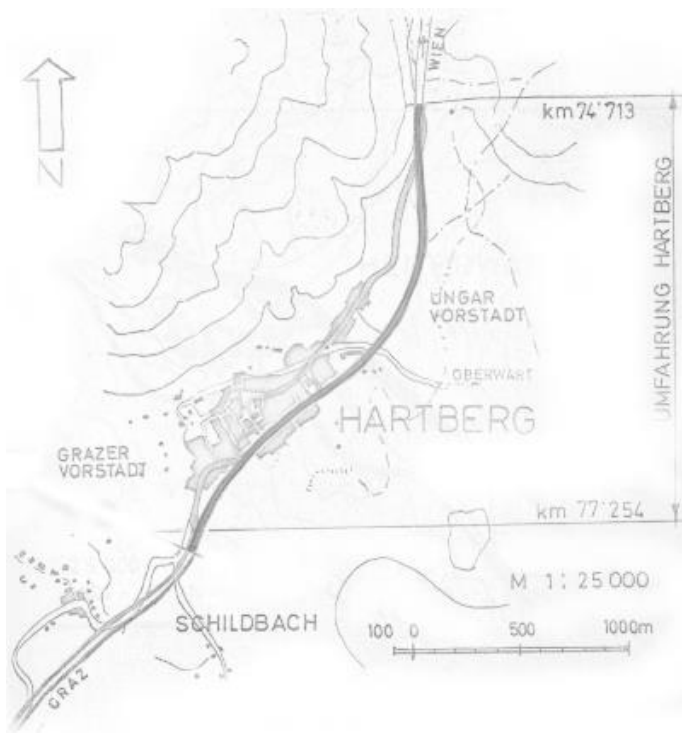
Lageplan um 1960 (Quelle: Dissertation RM)
